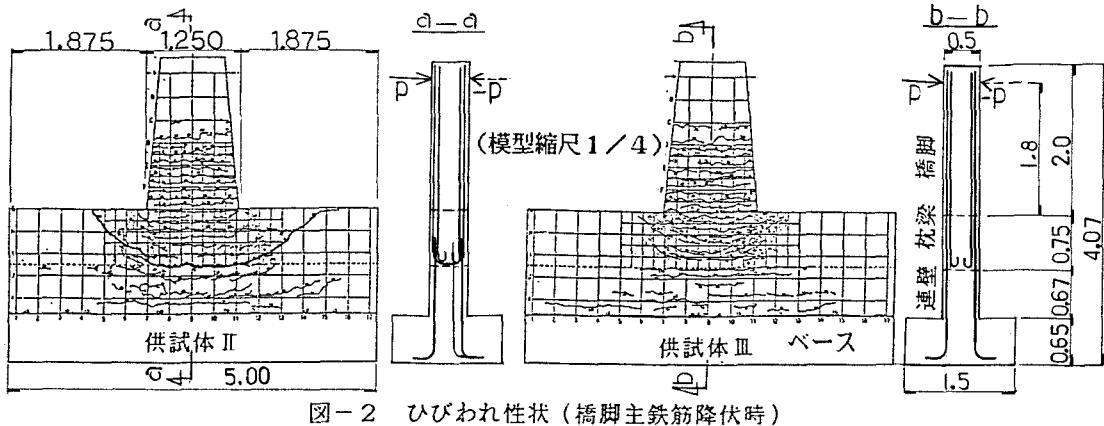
ひびわれ性状(橋脚主鉄筋降伏時)
